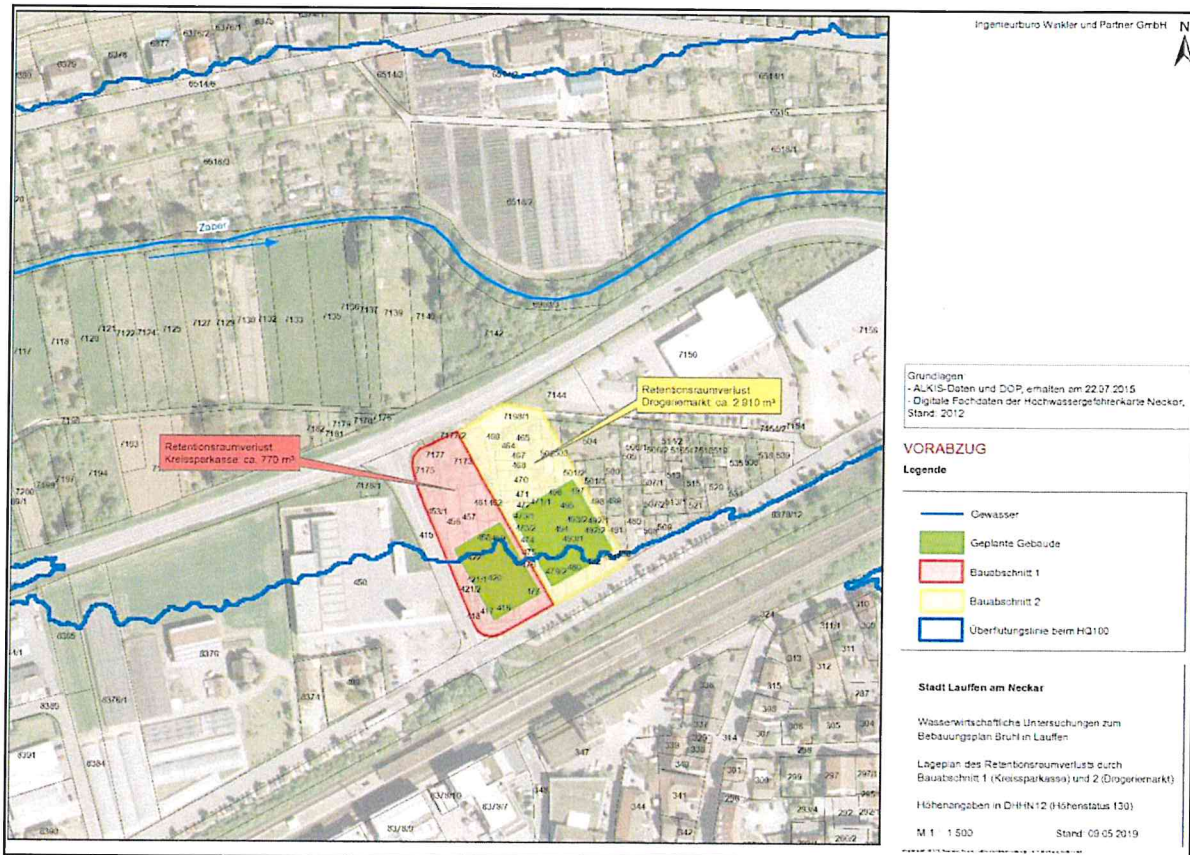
Lageplan Retentionsraumverlust durch Bauabschnitt 1 und 2
